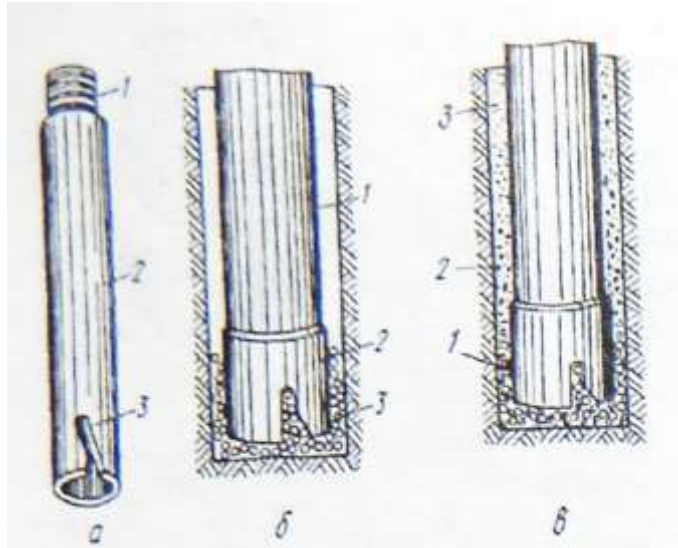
Дробова коронка та схема її роботи в забої свердловини:
